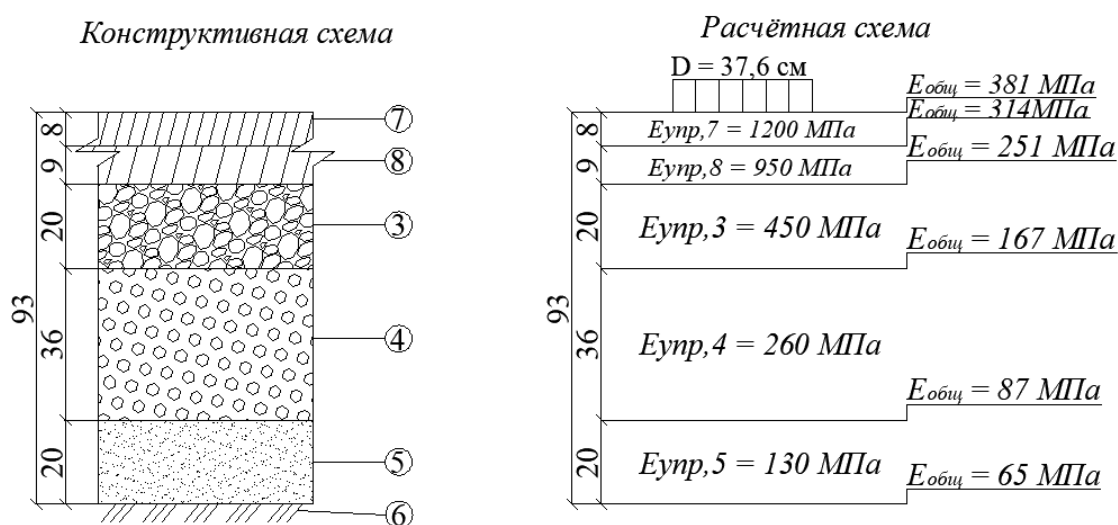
Конструктивная и расчетная схемы дорожной конструкции с покрытием из теплого немодифицированного асфальтобетона
